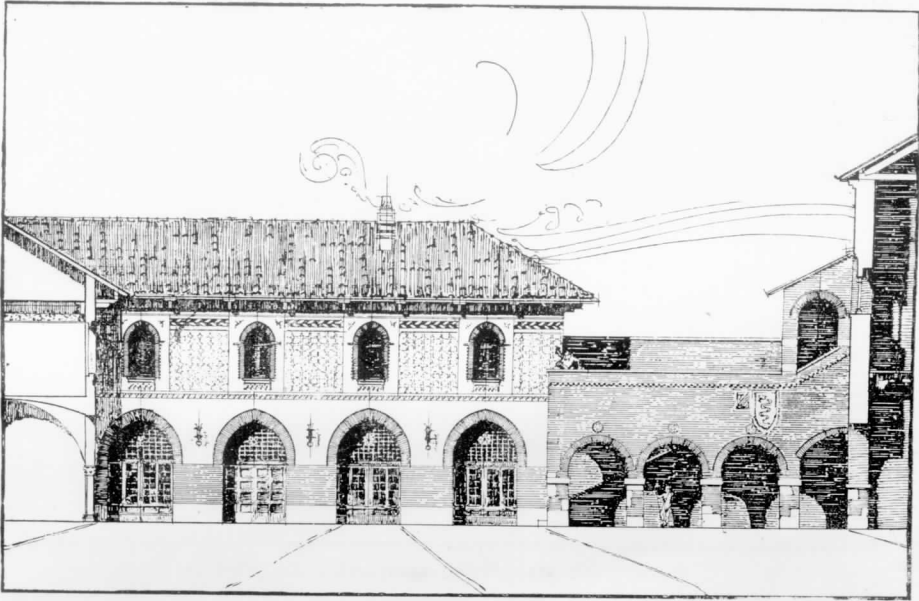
Sezione trasversale del cortile del Broletto con vista del prospetto di ponente
